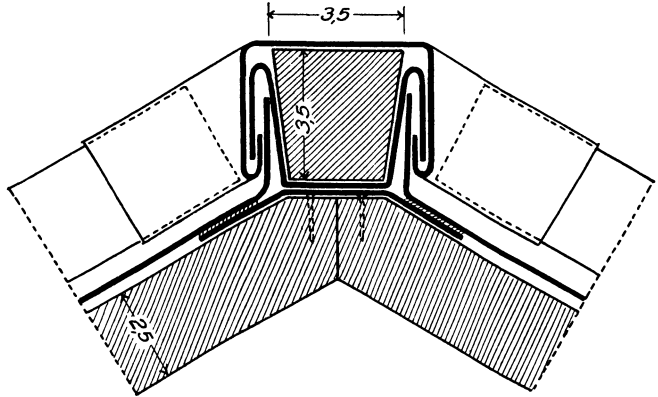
Zinkleistendach. Eindeckung des Firstes.
